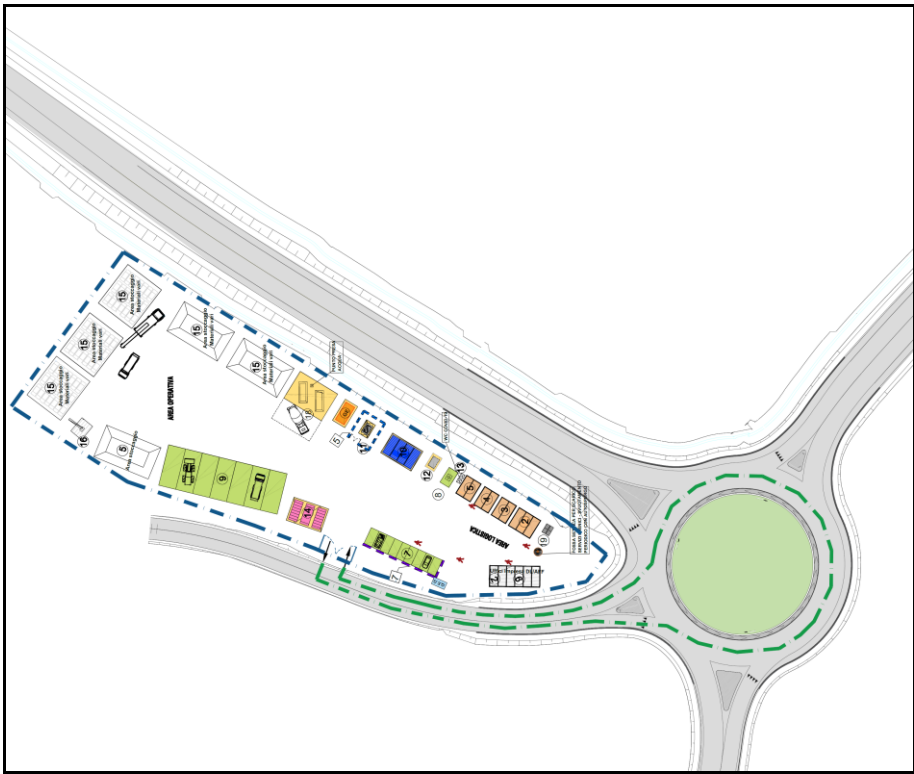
elaborati progettuali (planimetria generale cantiere, campo base 2)
